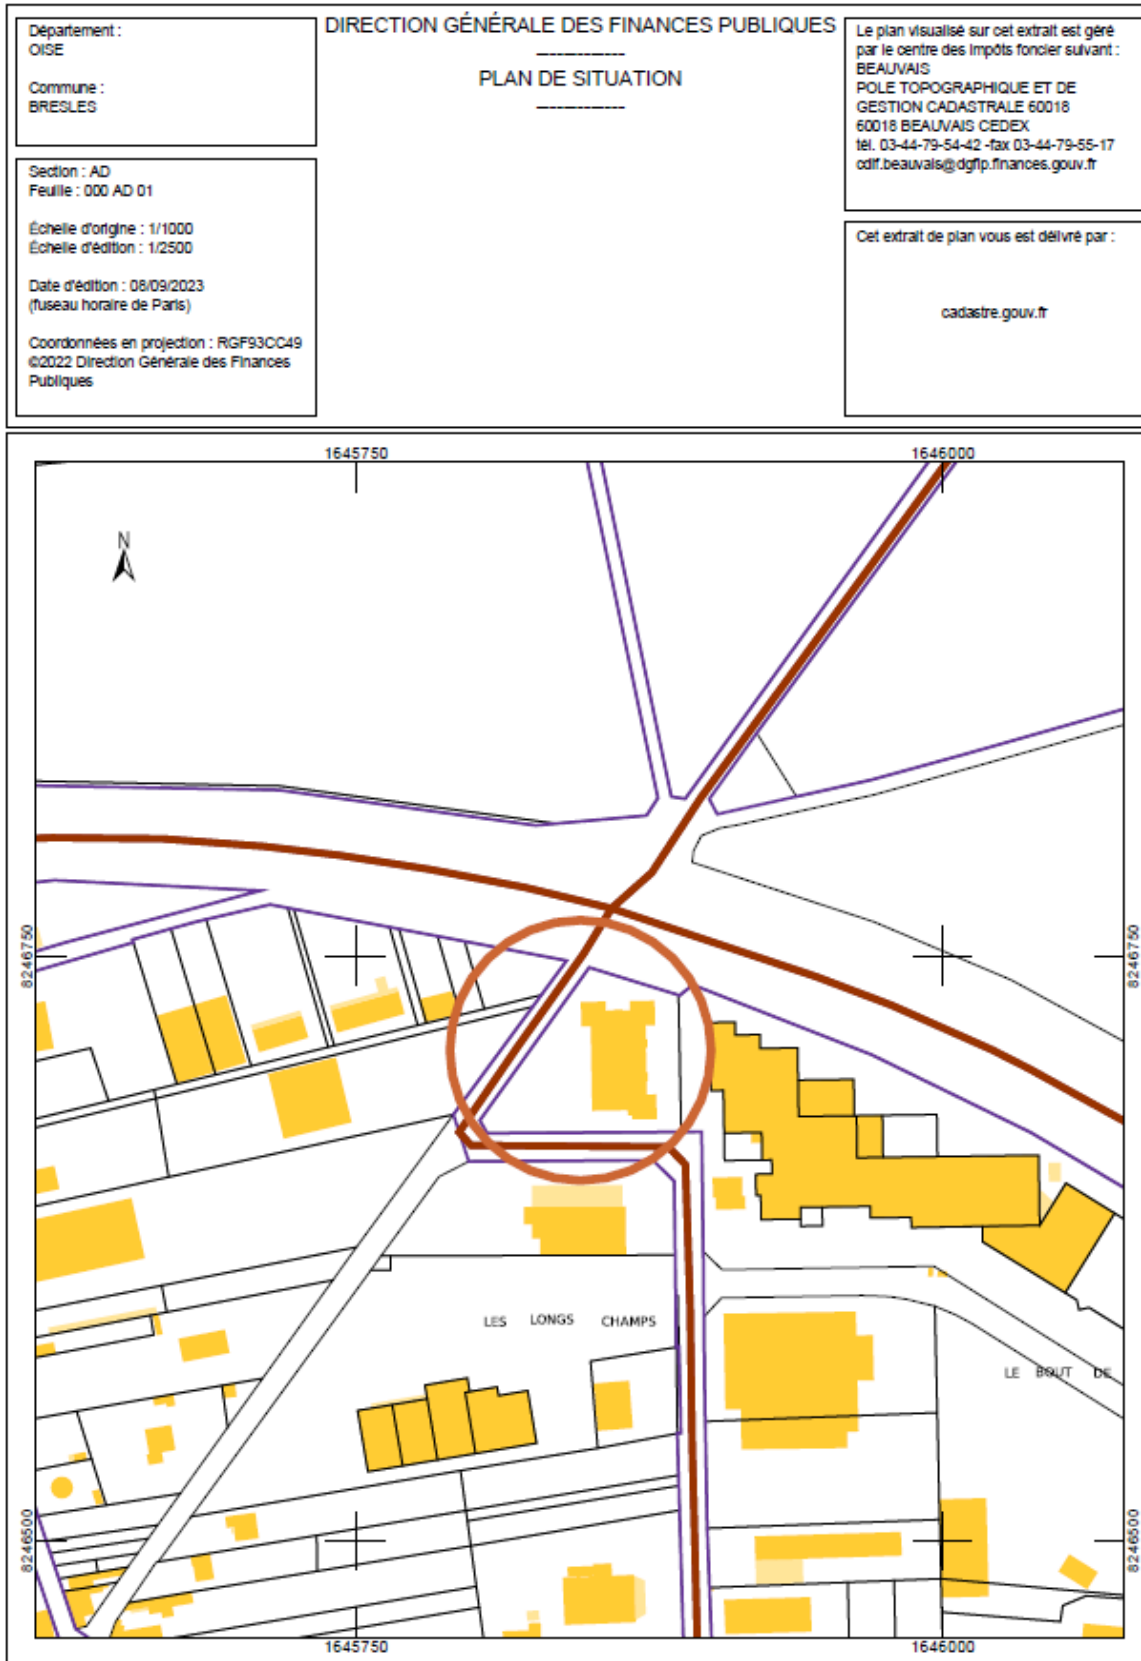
PLAN CADASTRAL DU SITE ACTUEL
